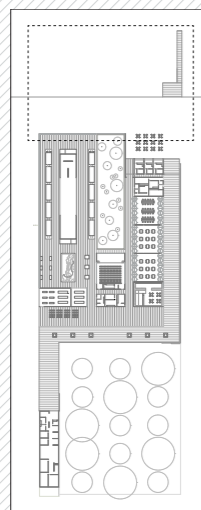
Medidas planta arquitectónica-galpones longitudinales
